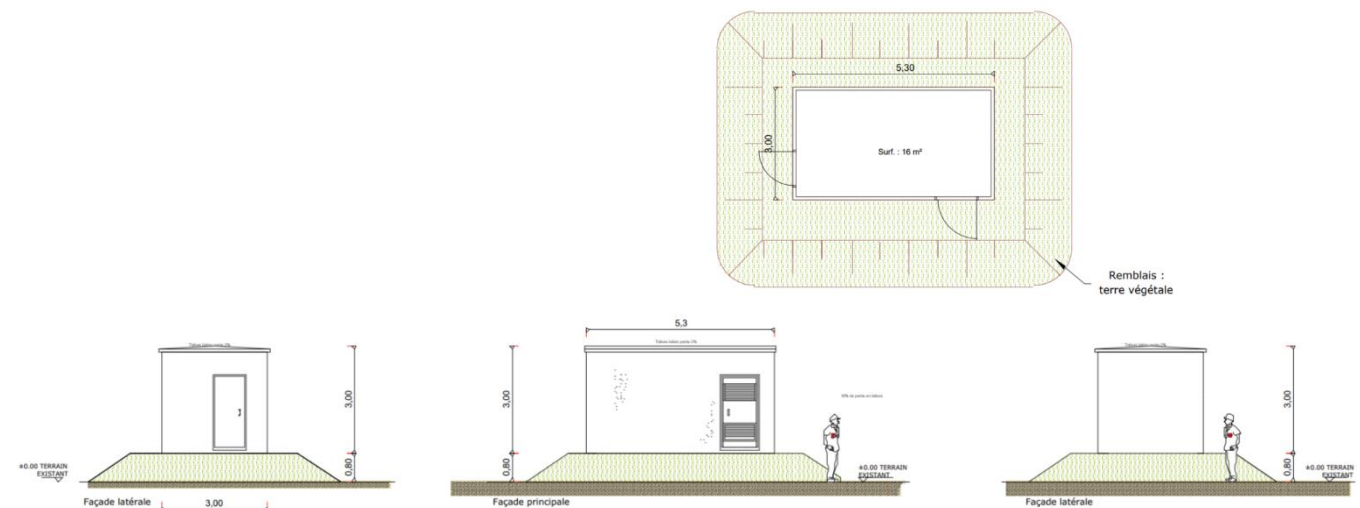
Vues en coupe du poste transformation prévu sur site (source : Urbasolar)
